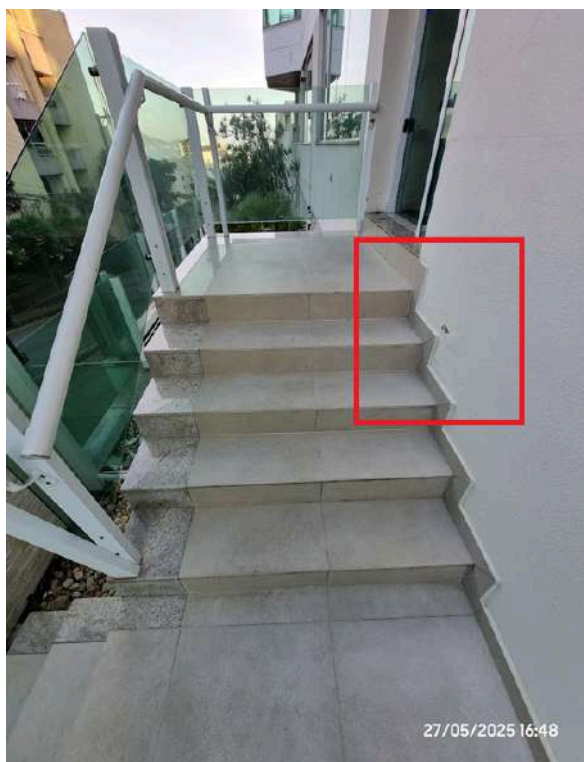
Fissura/trinca/ rachadura e empolamento/deslocamento da pintura/reboco em muro próximo à entrada da garagem térrea
